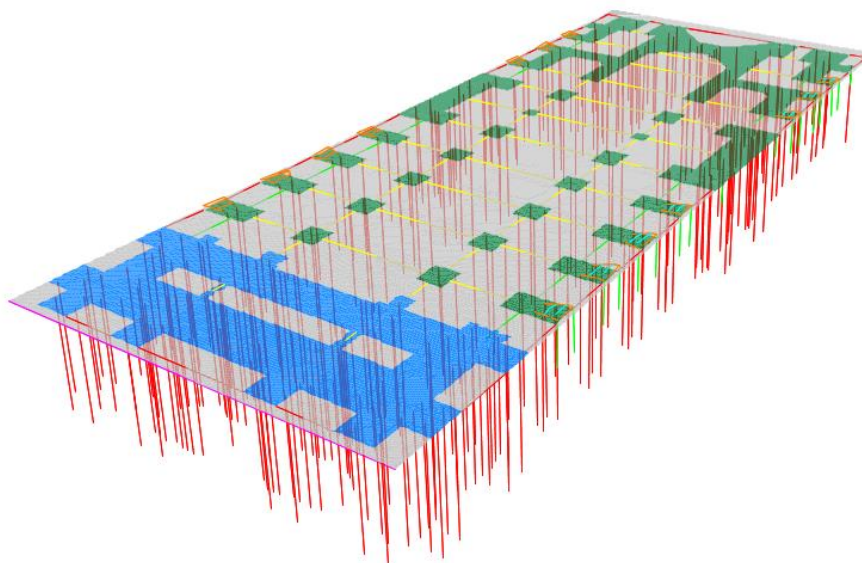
Vista general de la losa de aislamiento sísmico soportada por micropilotes (rojos) y apoyos sobre pilas (verdes) (no se muestra la estructura de albañilería solo por simplicidad de la figura)
